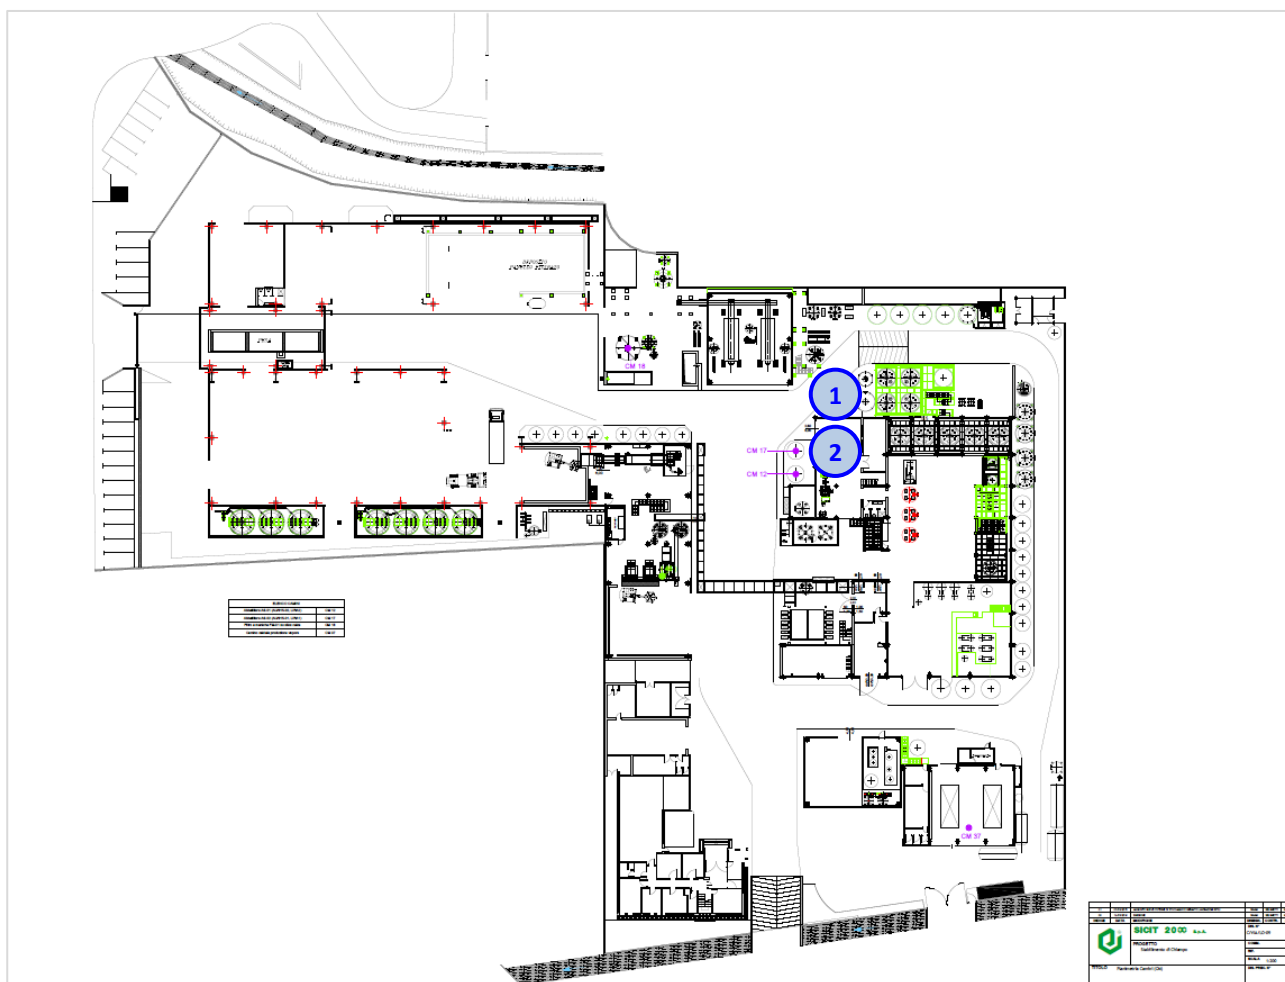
Planimetria dell'impianto SICIT 2000 S.p.A.
